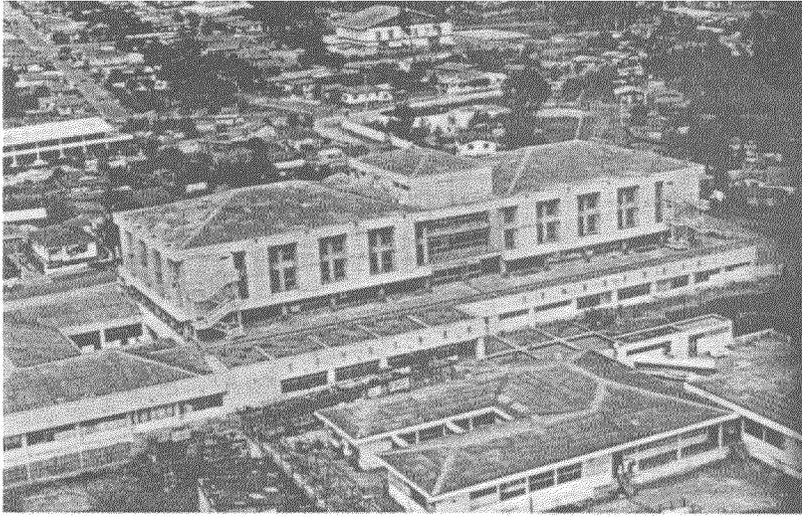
(a)—Vista general de un edificio de hormigón armado de cuatro pisos, dividido en dos mitades por una junta de expansión. Una de las mitades fue dañada en el terremoto de Chile de 1985.
